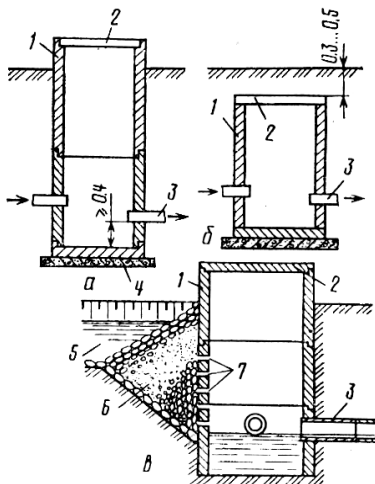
Смотровой колодец из железобетонных колец (а – открытый, б – потайной) и водоприемный колодец (в): 1 – железобетонная труба; 2 – крышка; 3 – коллекторная труба; 4 – днище; 5 – канал; 6 – фильтр; 7 – отверстия для поступления воды. Размеры в м
